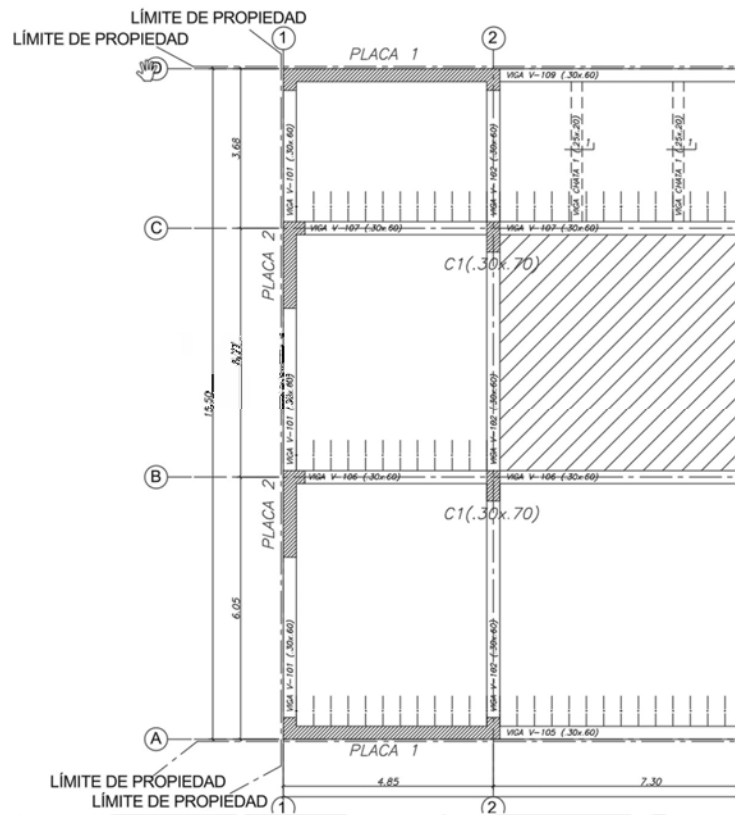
Ubicación en planta de la vigueta a analizar
